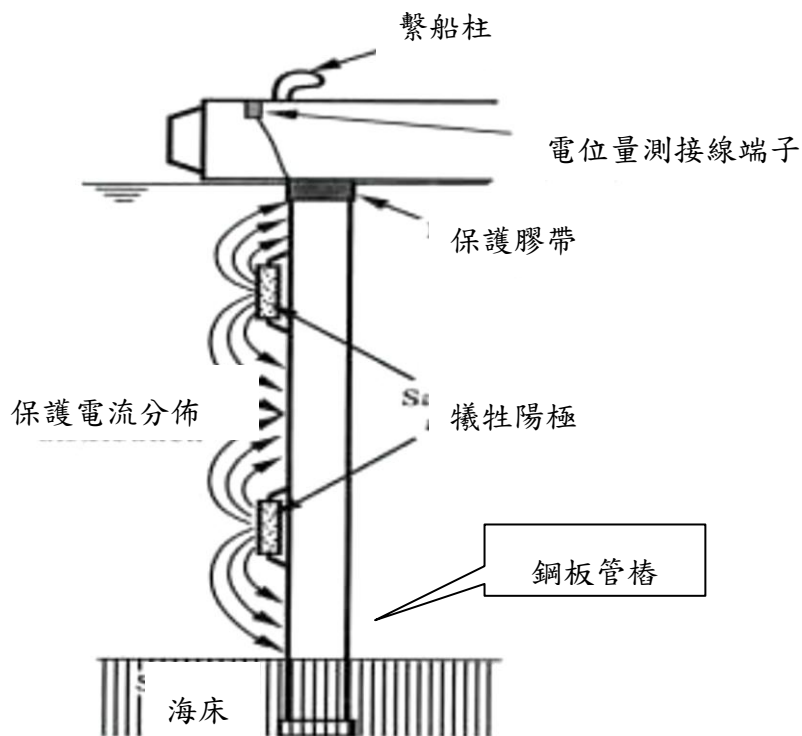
碼頭鋼板(管)樁_犧牲陽極法
